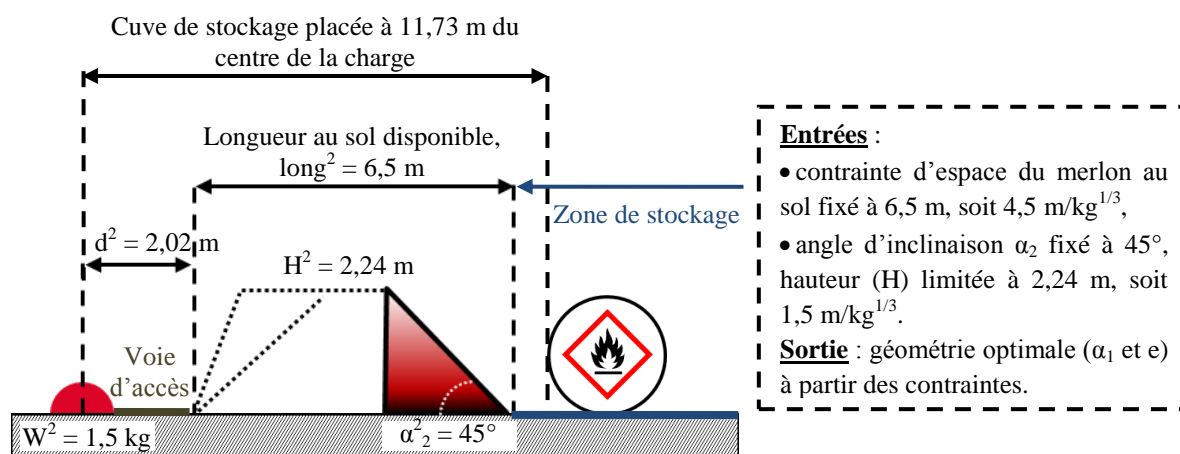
Exemple de dimensionnement d'une barrière de protection
